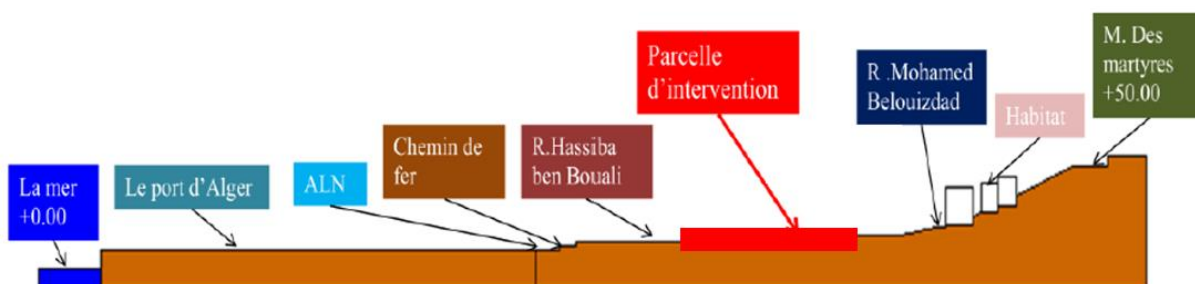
coupe schématique sur le site d'intervention. Source : auteur
